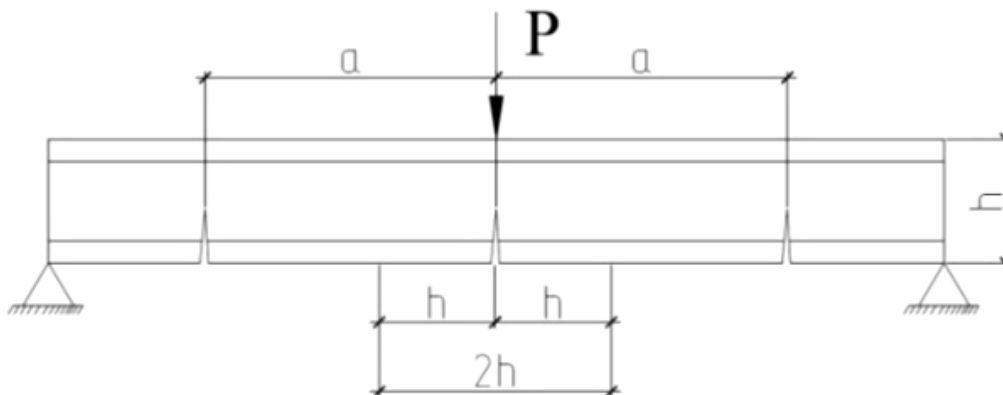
Расчетная схема железобетонной балки с трещинами
